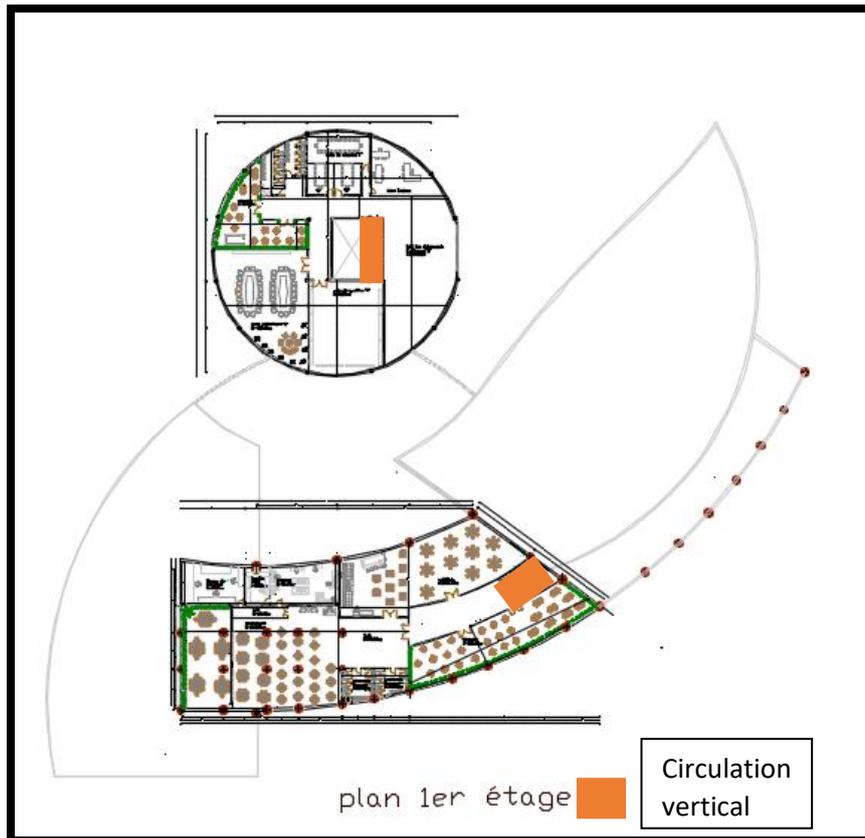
plan de 1er étage. Source : traite par l'auteur.
